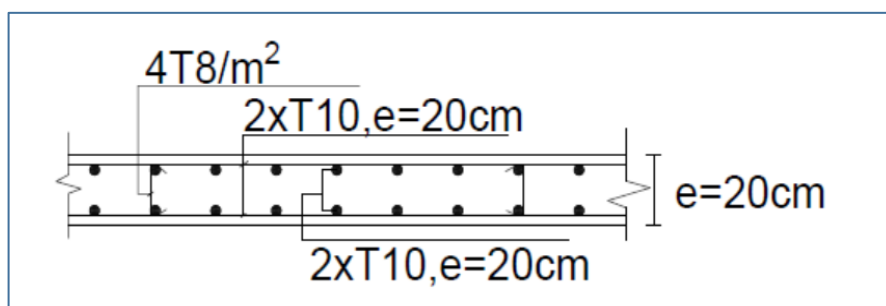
Ferrailage de voiles périphérique sens x-x.
